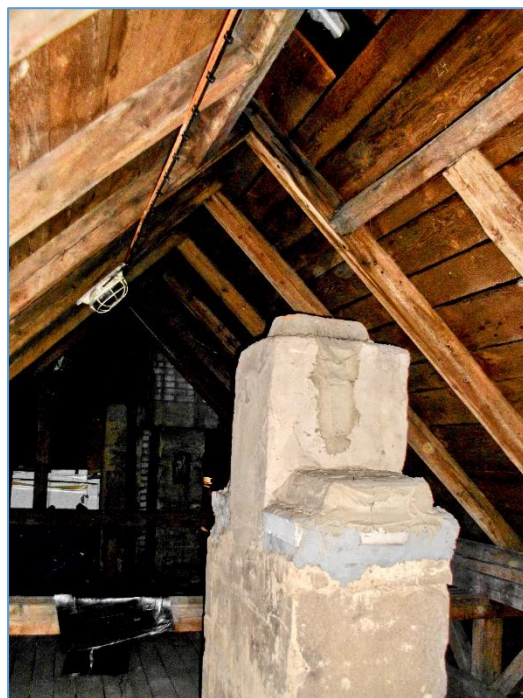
KONSTRUKČNÍ SPOJ KROVU
